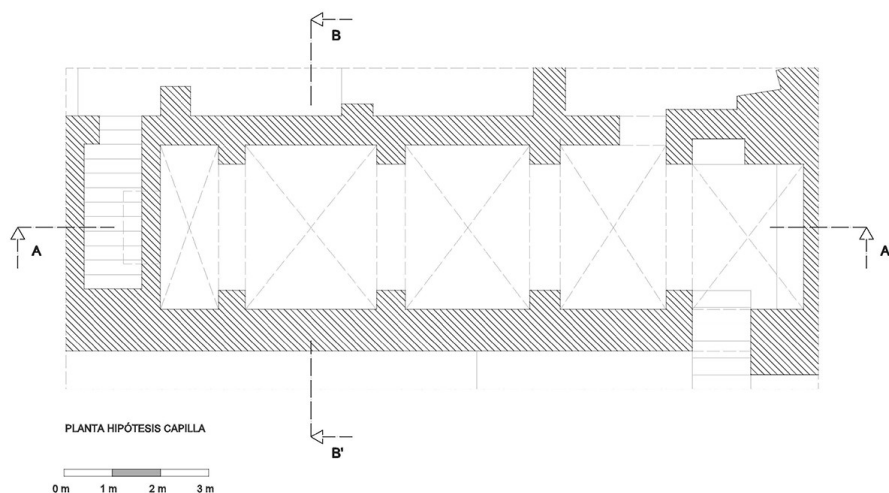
Planta simplificada para la hipótesis de la cubierta
